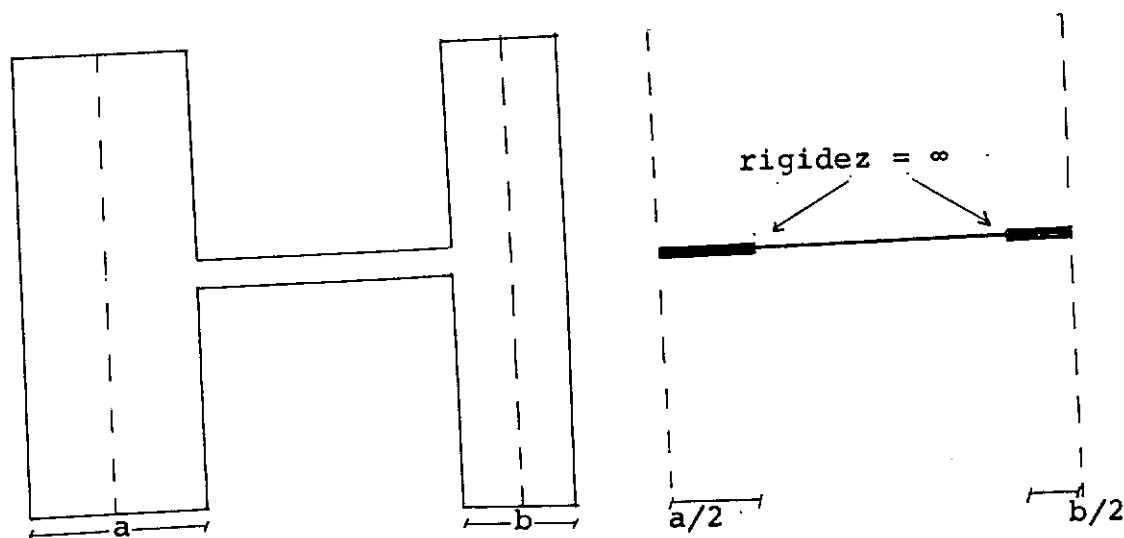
Pilar parede e sua idealização estrutural.
